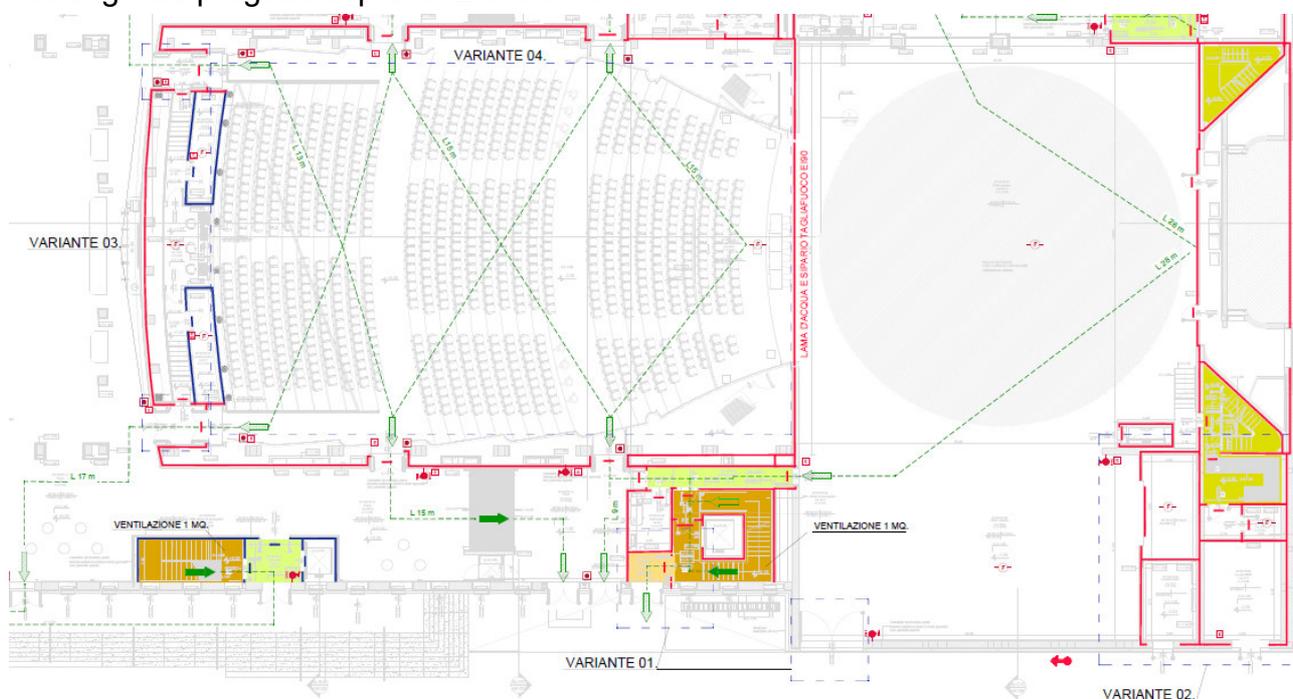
Planimetria Piano Terra e identificazione degli interventi
